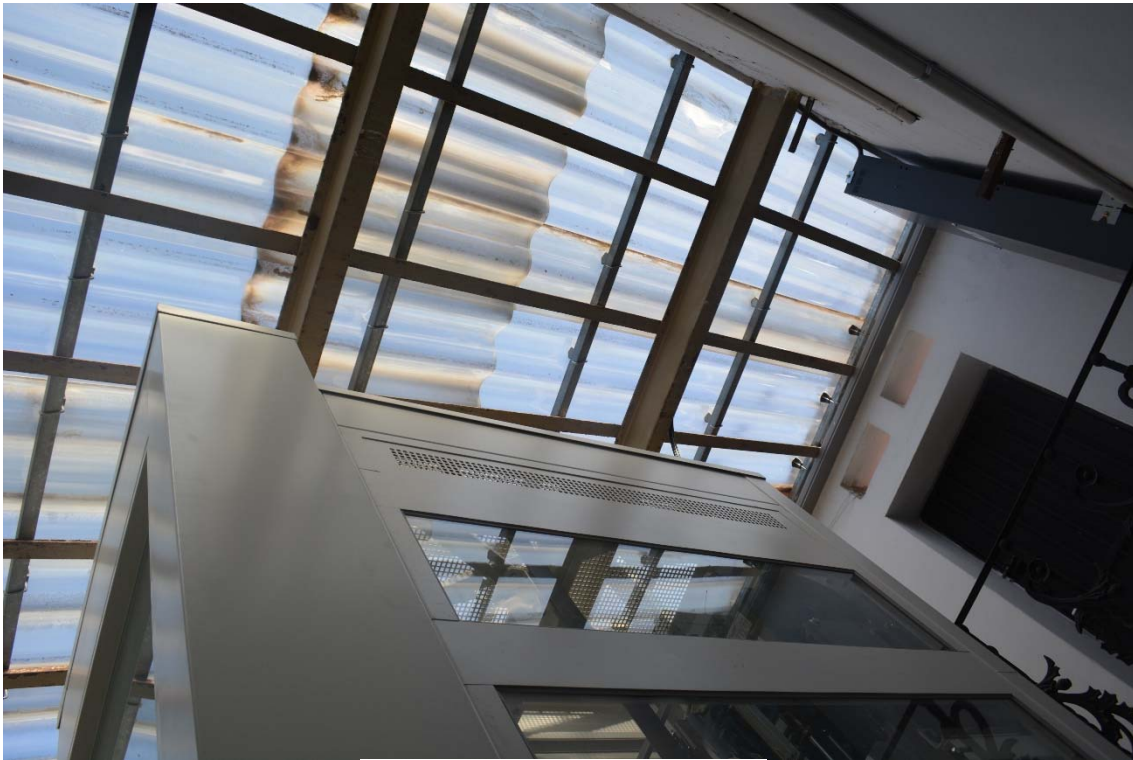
Imagen de la cubierta de la escalera (Planta 5ª). Fuente propia.
